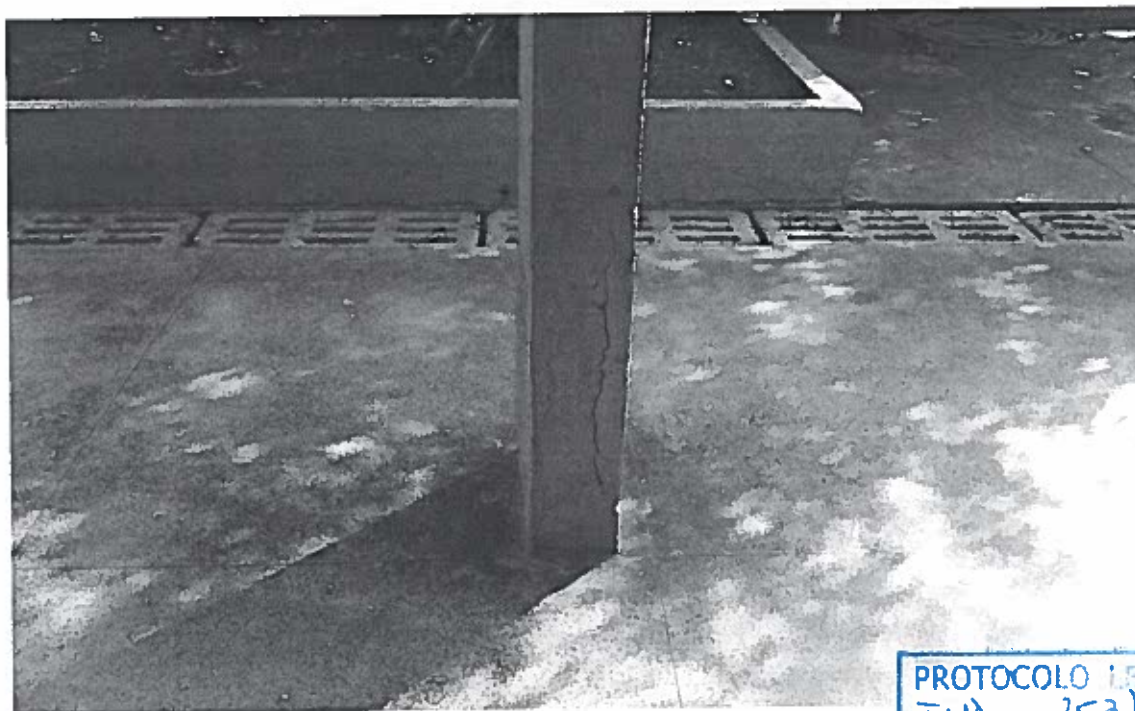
Pilar 60 – Rachadura vertical na base do pilar
